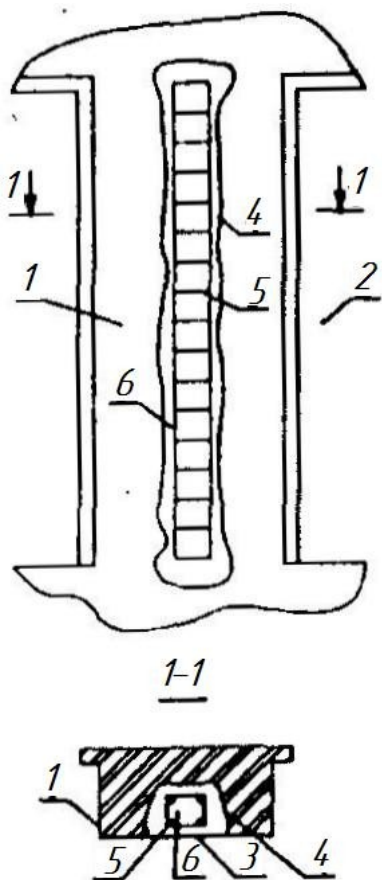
Улаштування залізобетонного сердечника: 1 – посилюваний простінок; 2 – прорізи; 3 – стояк (сердечник) із залізобетону; 4 – ніша, вирубана в простінку; 5 – бетон
